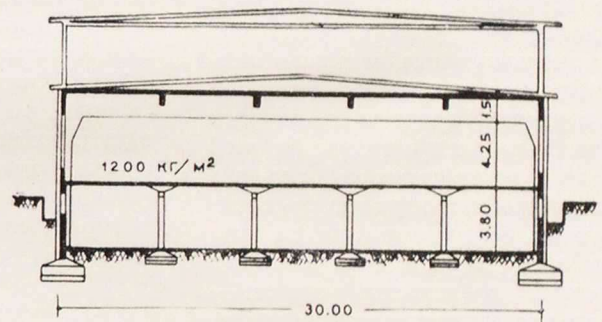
Производственное здание в 2—3 этажа с безбалочным перекрытием цокольного этажа
